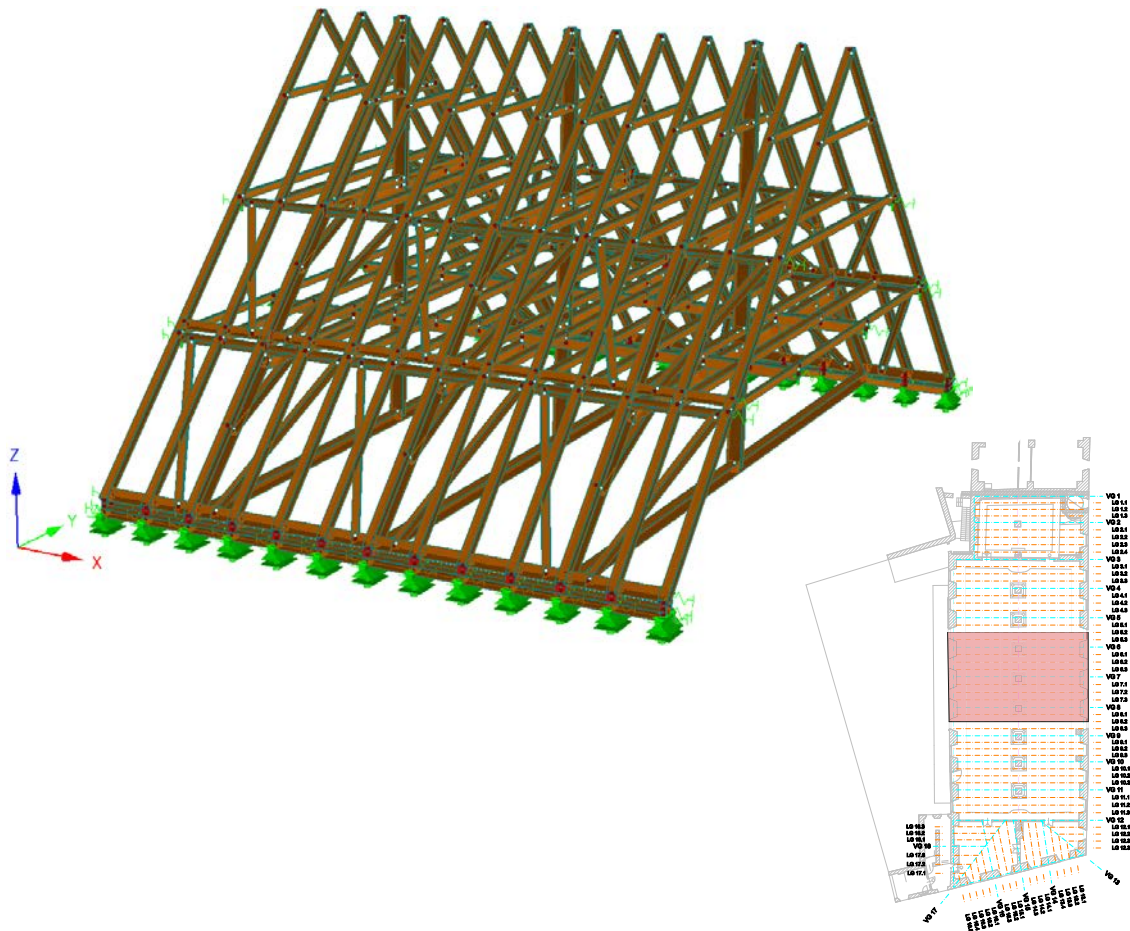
gewähltes Referenzsystem für statische dreidimensionale Berechnung des Dachtragwerkes sowie dessen Grundriss.
